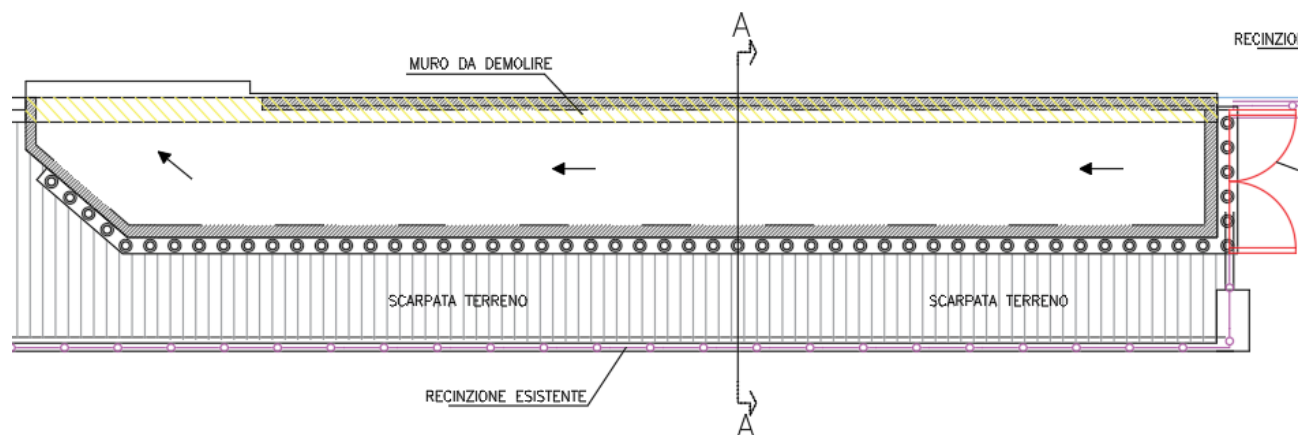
Planimetria rampa di accesso al Fiume Lambro Meridionale
